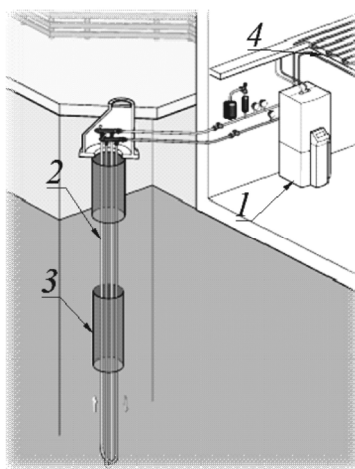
Схема вертикального грунтового зонда: 1 – установка теплового насоса; 2 – грунтовый теплообменник; 3 – бетонное заполнение зонда; 4 – система отопления
